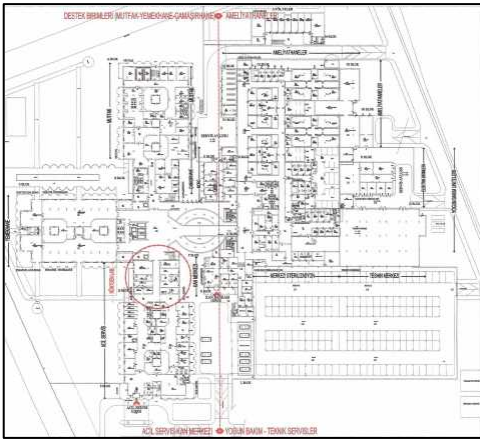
Vaziyet Planı, Kesit ve Görünüşler
